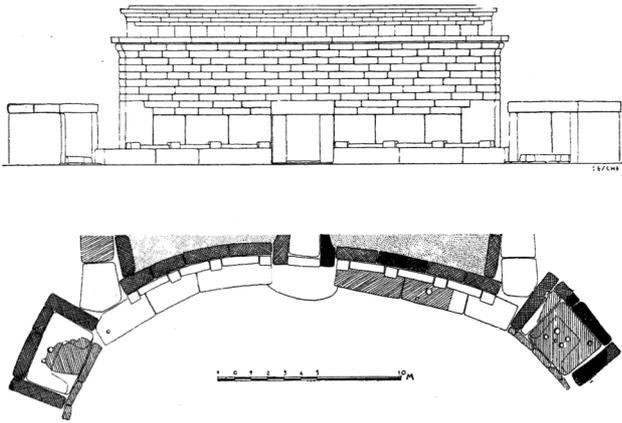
Tarxien. Pianta e prospetto ricostruttivo della facciata del I tempio (CESCHI 1939)
